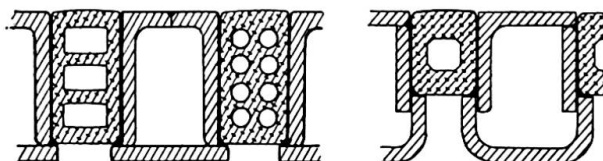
Elasthohlleisten zwischen tragenden Stahllamellen.
